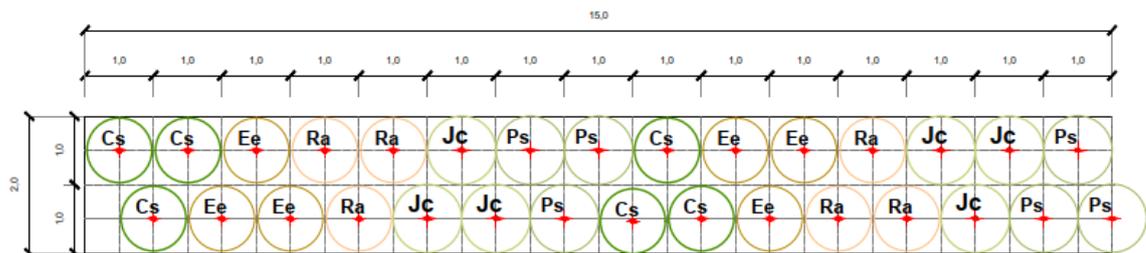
Planimetria del sesto d'impianto del MODULO F
